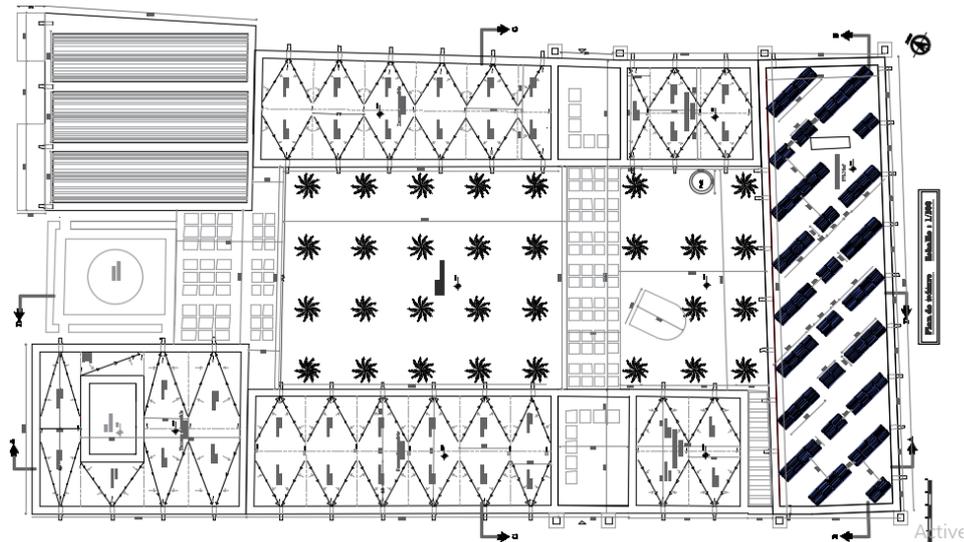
plan d'installation des panneaux photovoltaïques sur la toiture de bloc des ateliers source : auteur
